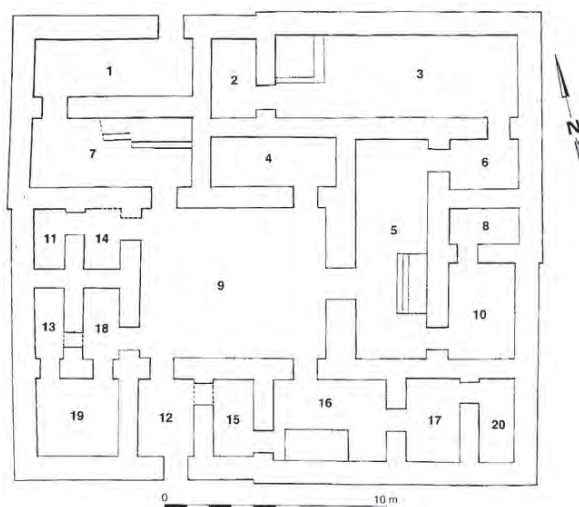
Plan de la maison B 27 de Larsa (dessin J. Suire)
